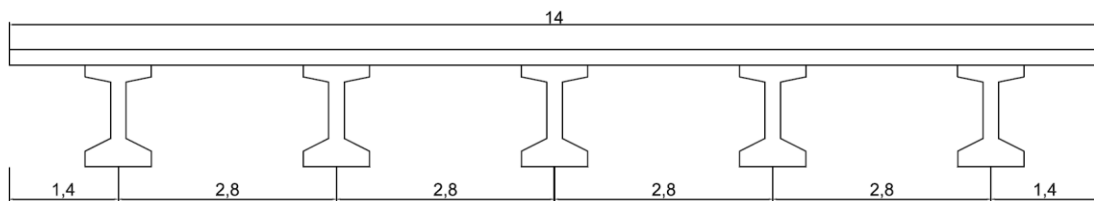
Sección transversal de vigas prefabricadas doble T dimensionada
